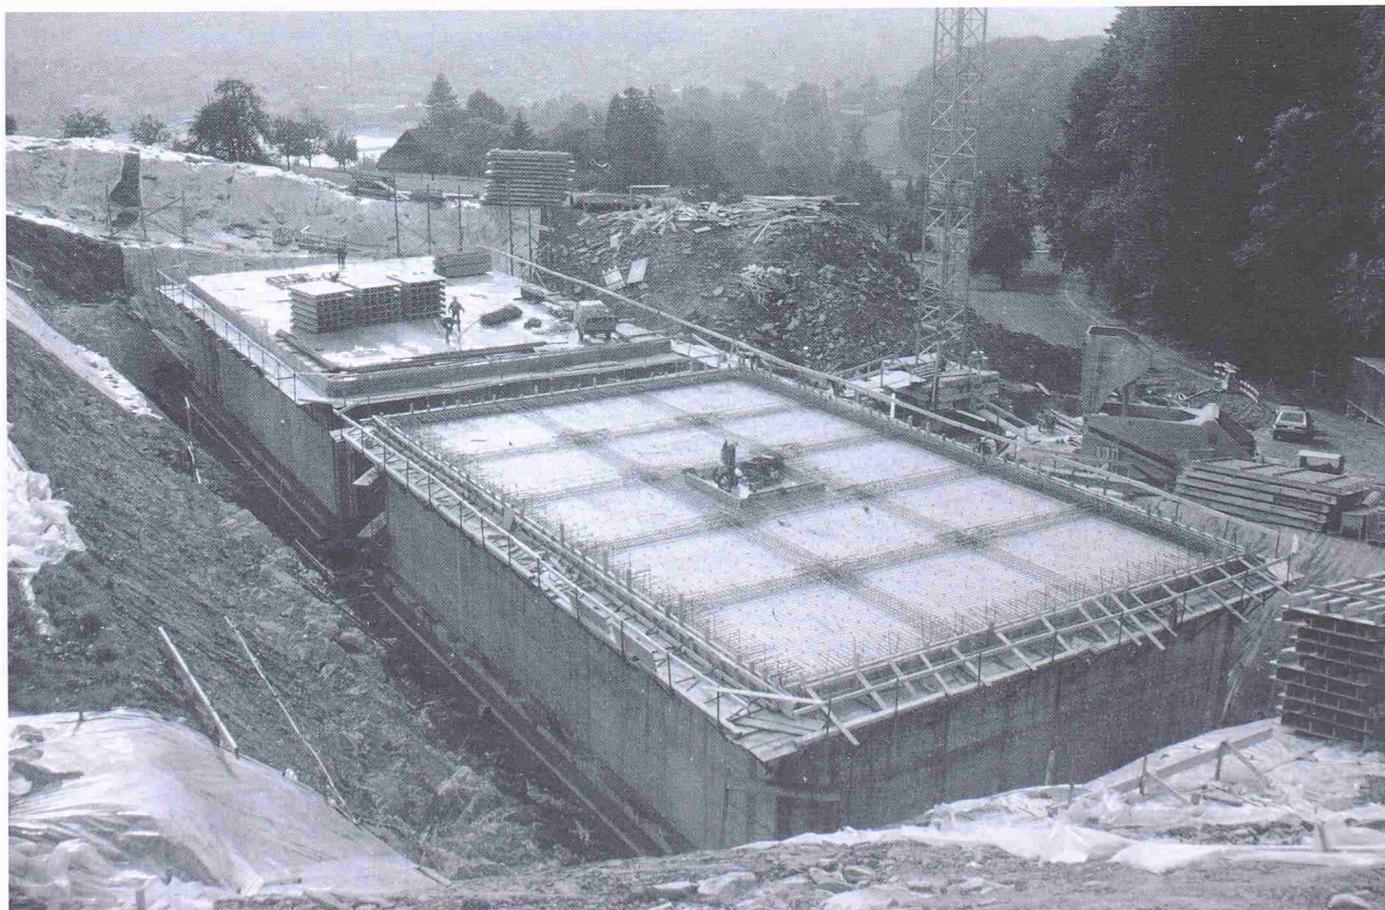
Gesamtansicht des Trinkwasserreservoirs vor dem Betonieren der vorgespannten Decken
